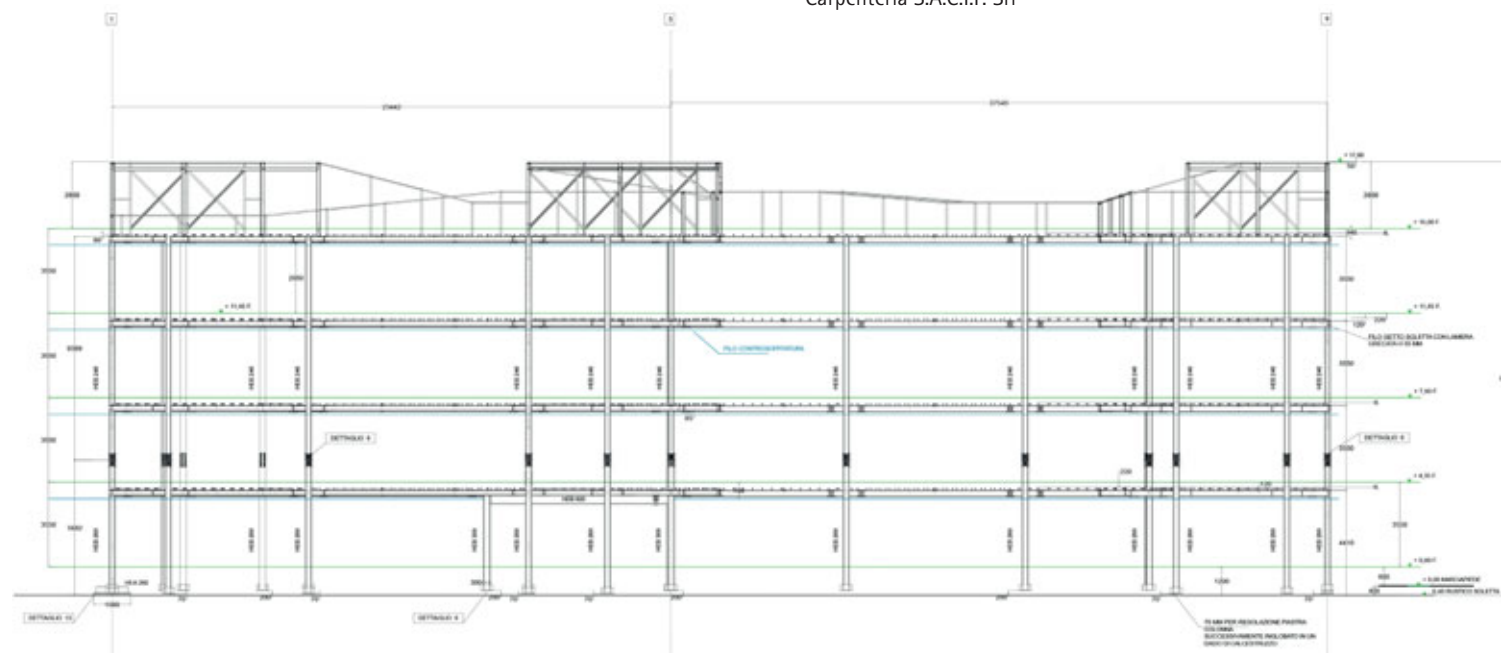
Prospetto quotato della struttura portante e delle strutture in copertura. © Carpenteria S.A.C.I.F. Srl
